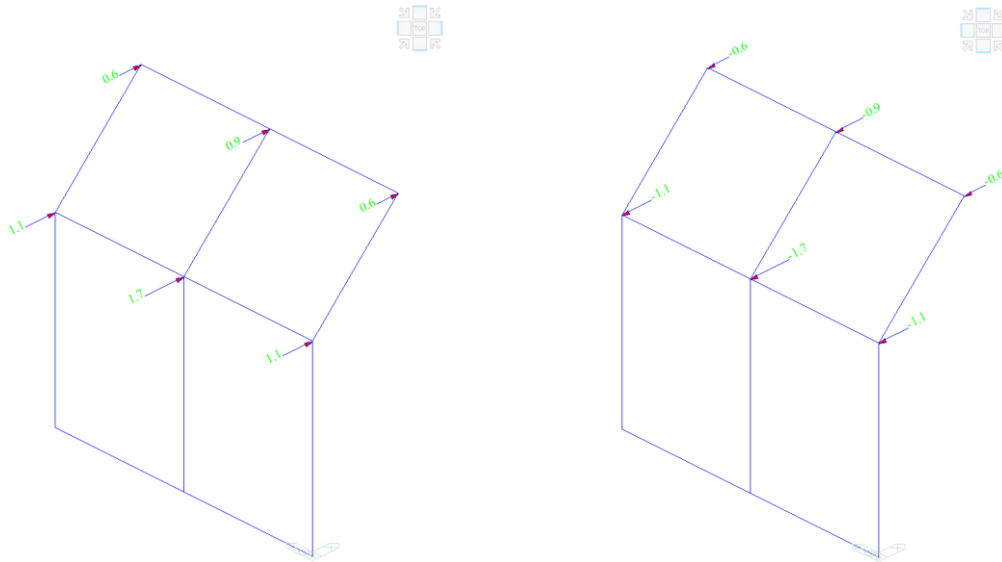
carico dovuto all'azione sismica SLV +/- SLV - [kN/m]
